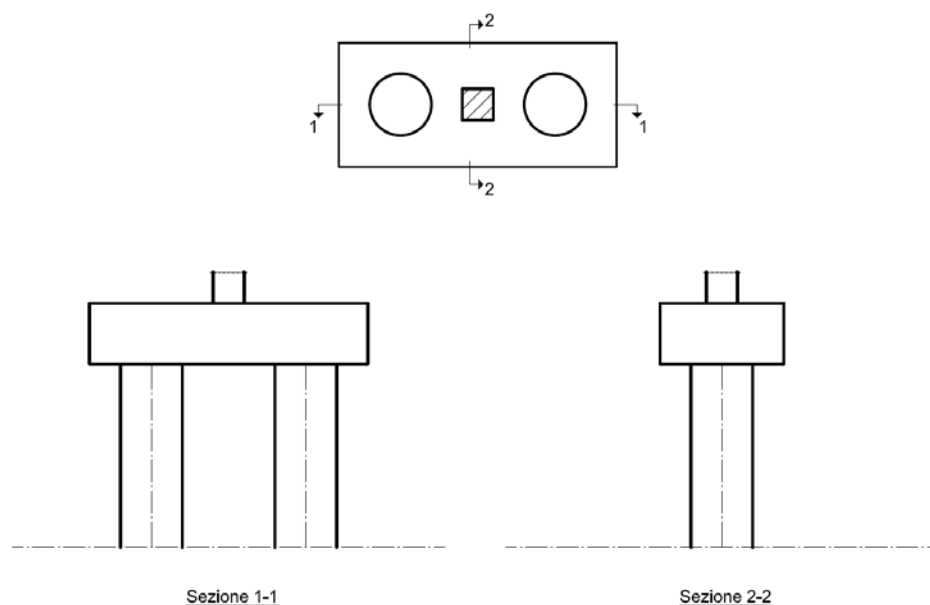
Configurazione adottata per le fondazioni dei pilastri.
